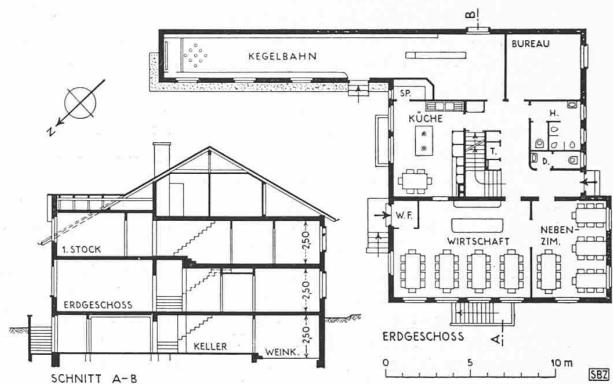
Wirtshaus Nägelsee, Grundriss und Schnitt 1:400
